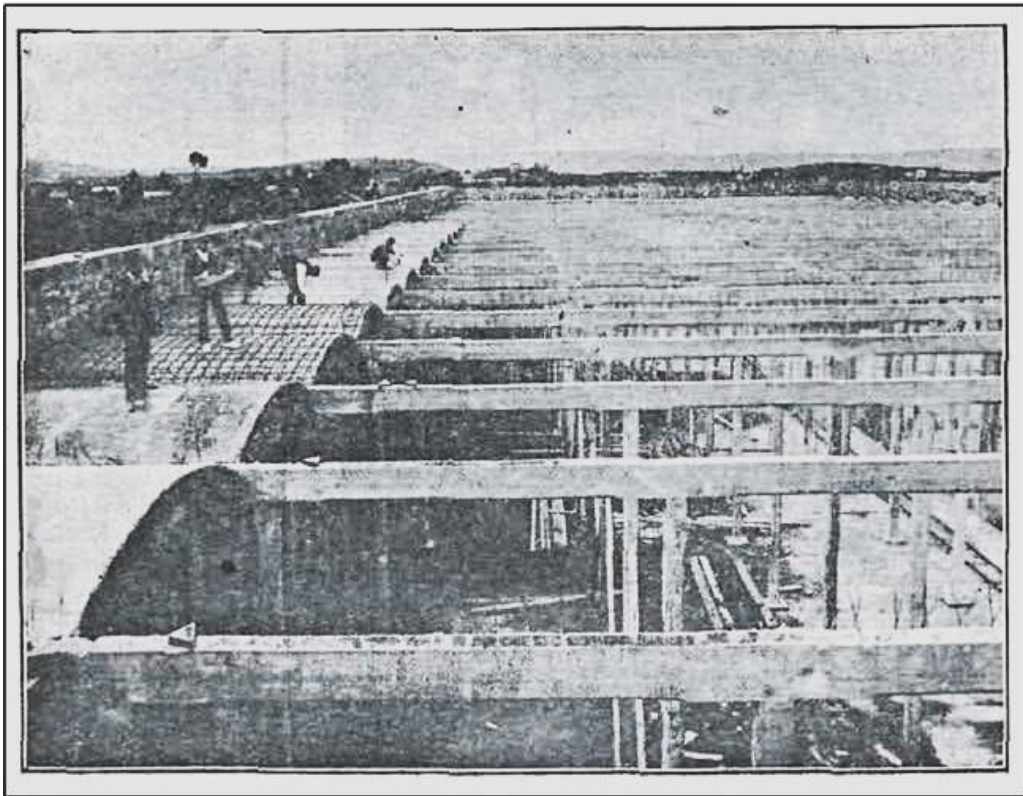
Cubierta del depósito de agua de Gijón en construcción. Revista La Construcción Moderna No.5 1903
